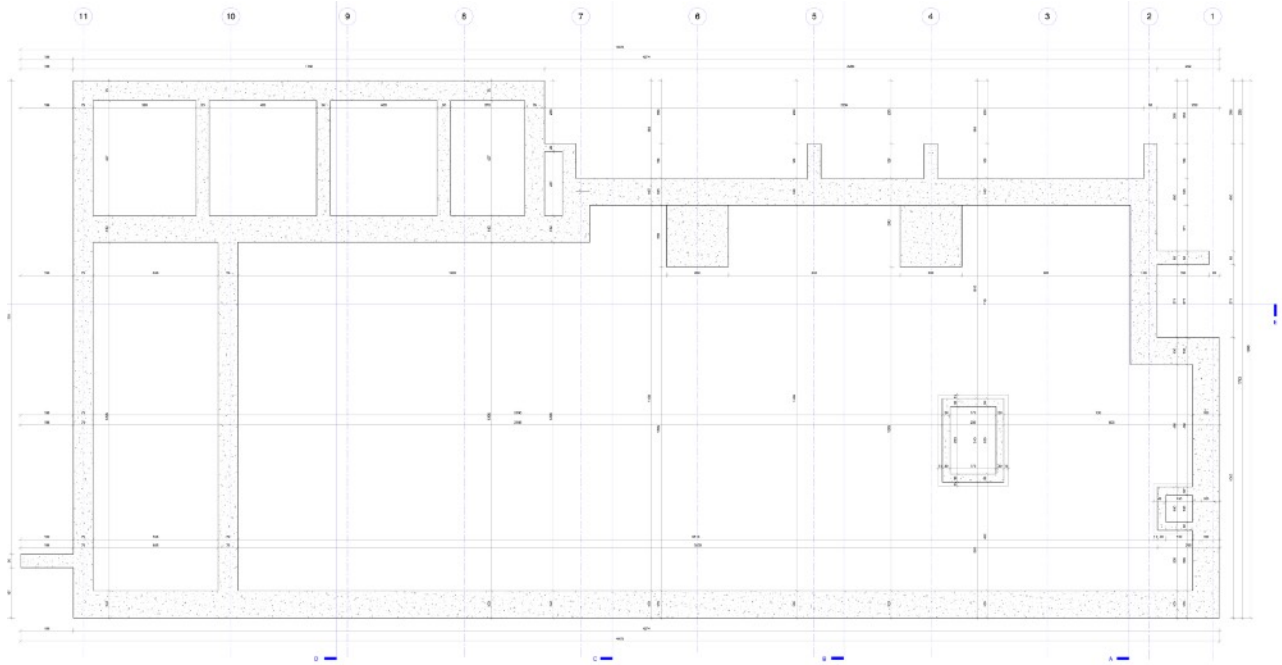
PLAN 20. Funderingsplan Kantine. © Artesta architecten & ingenieurs
